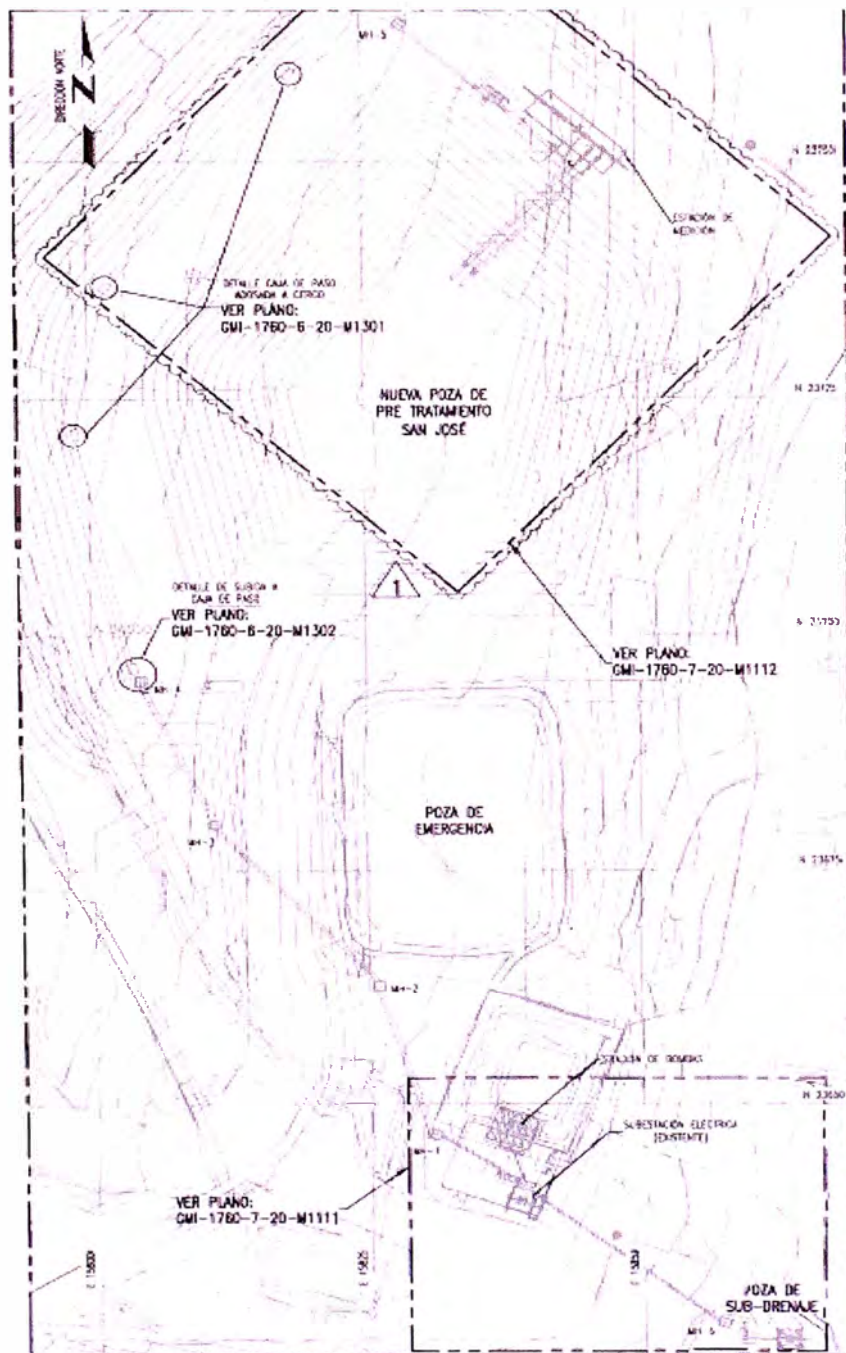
Vista de planta de las pozas cercanas a NSJ1
